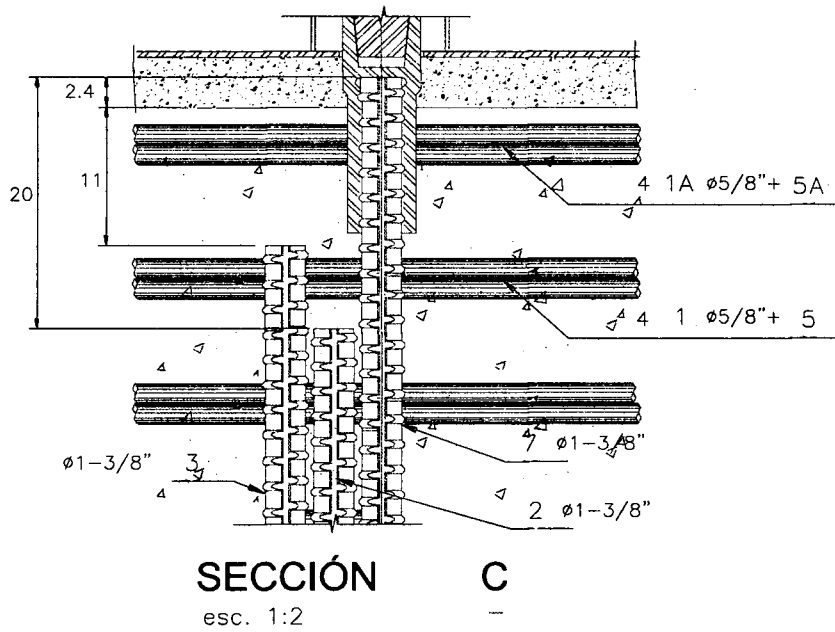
Detalle del encuentro entre el acero de columna y viga cabezal.
